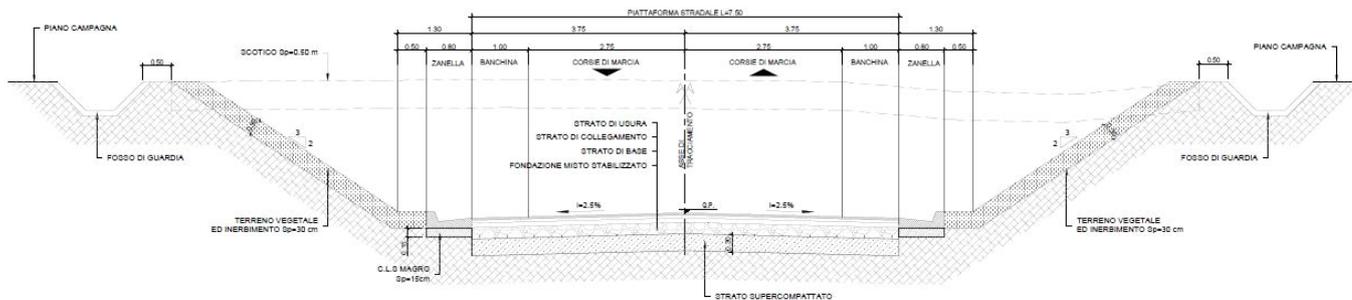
Dest. Particolare 7.5m – sezione tipo in trincea
